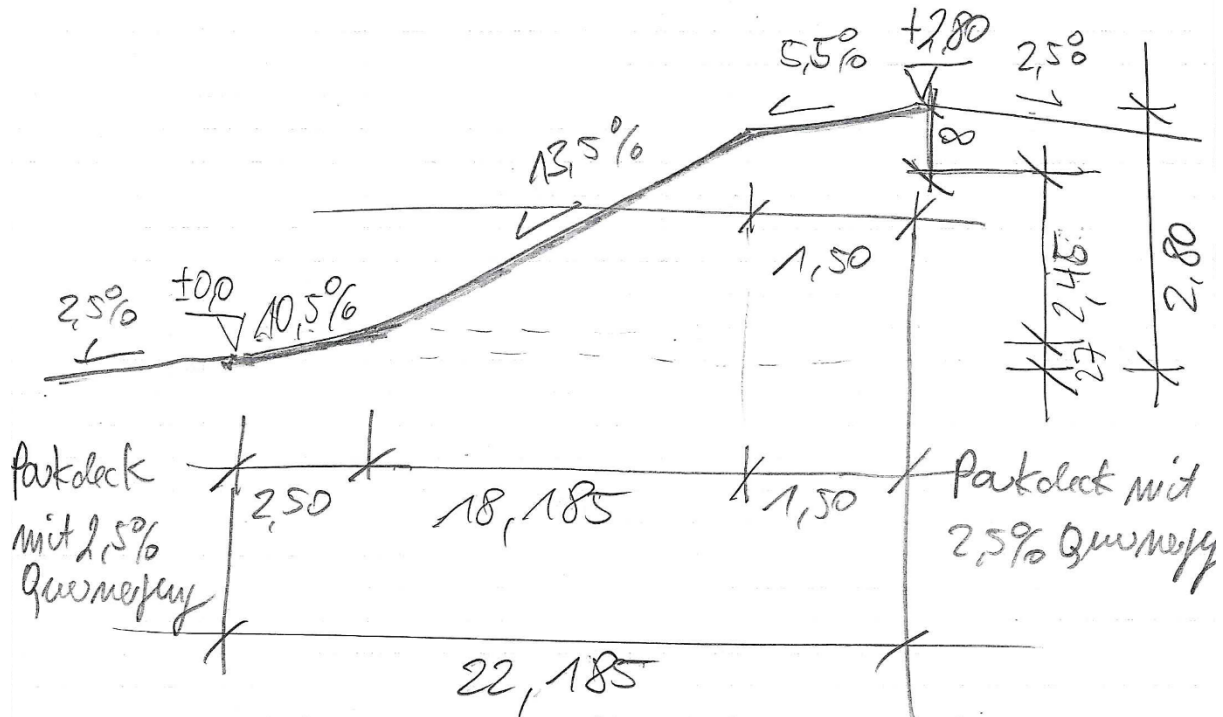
Rampenneigungen bei Vollgeschosssrampe mit Abflachungen
